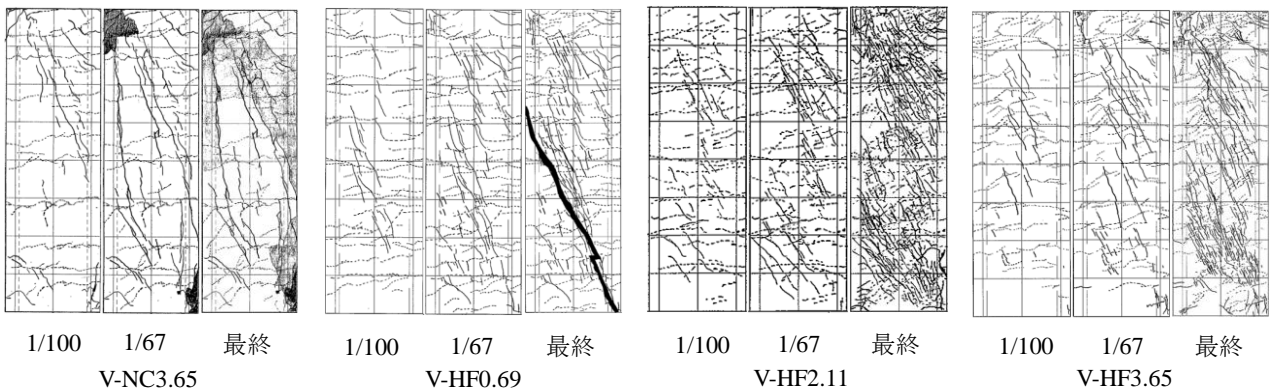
ひび割れ状況 (右方向が水平載荷の正方向)
